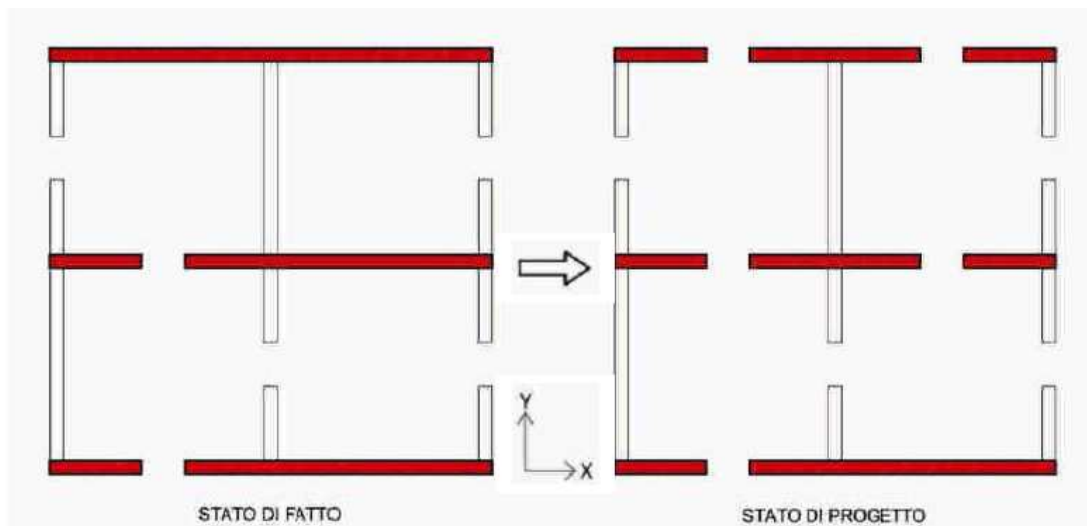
Schema per la valutazione dell'area resistente della muratura in direzione X
